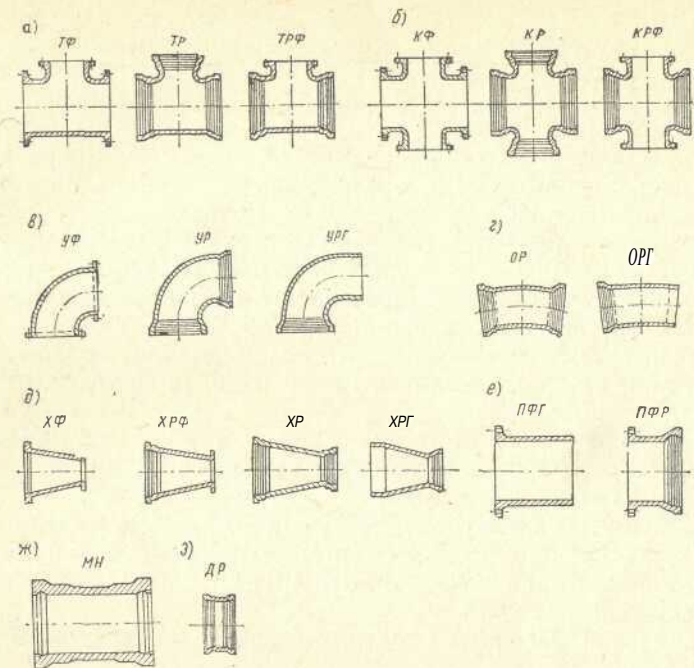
Чугунные водопроводные соединительные (фасонные) части
